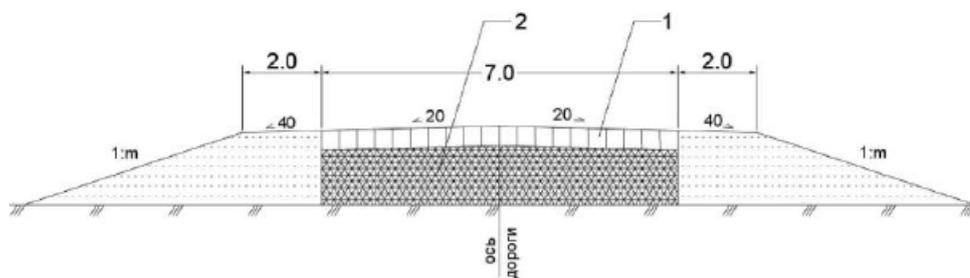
Конструкция дорожной одежды с основанием из укрепленной АЩГС:
